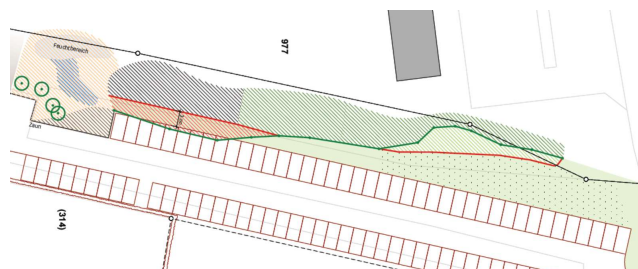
SOLL-Situation Hecke (massstabslos, siehe Plan Beilage 2)
